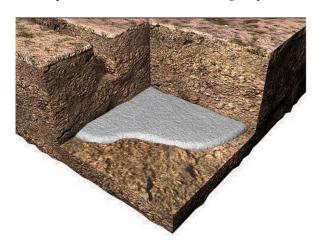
Esquemática lastro de concreto magro aplicado no solo.
